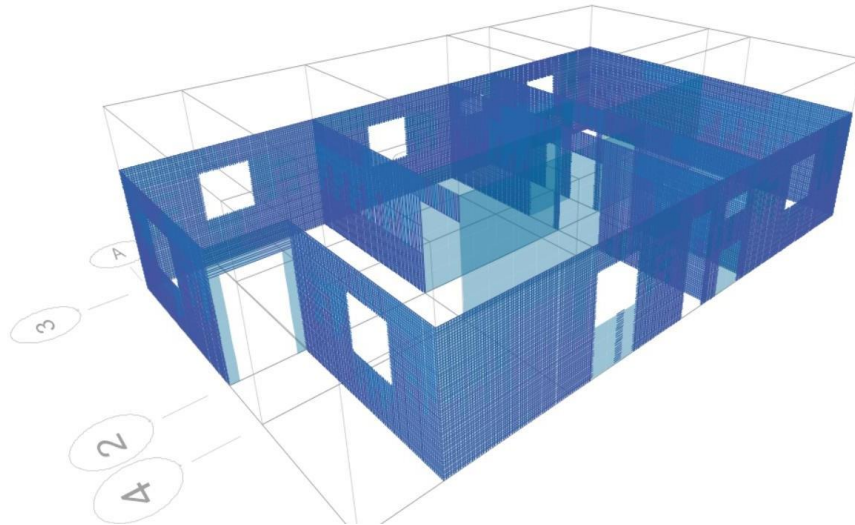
Modelo tridimensional de la estructura con reforzamiento con geomalla.
